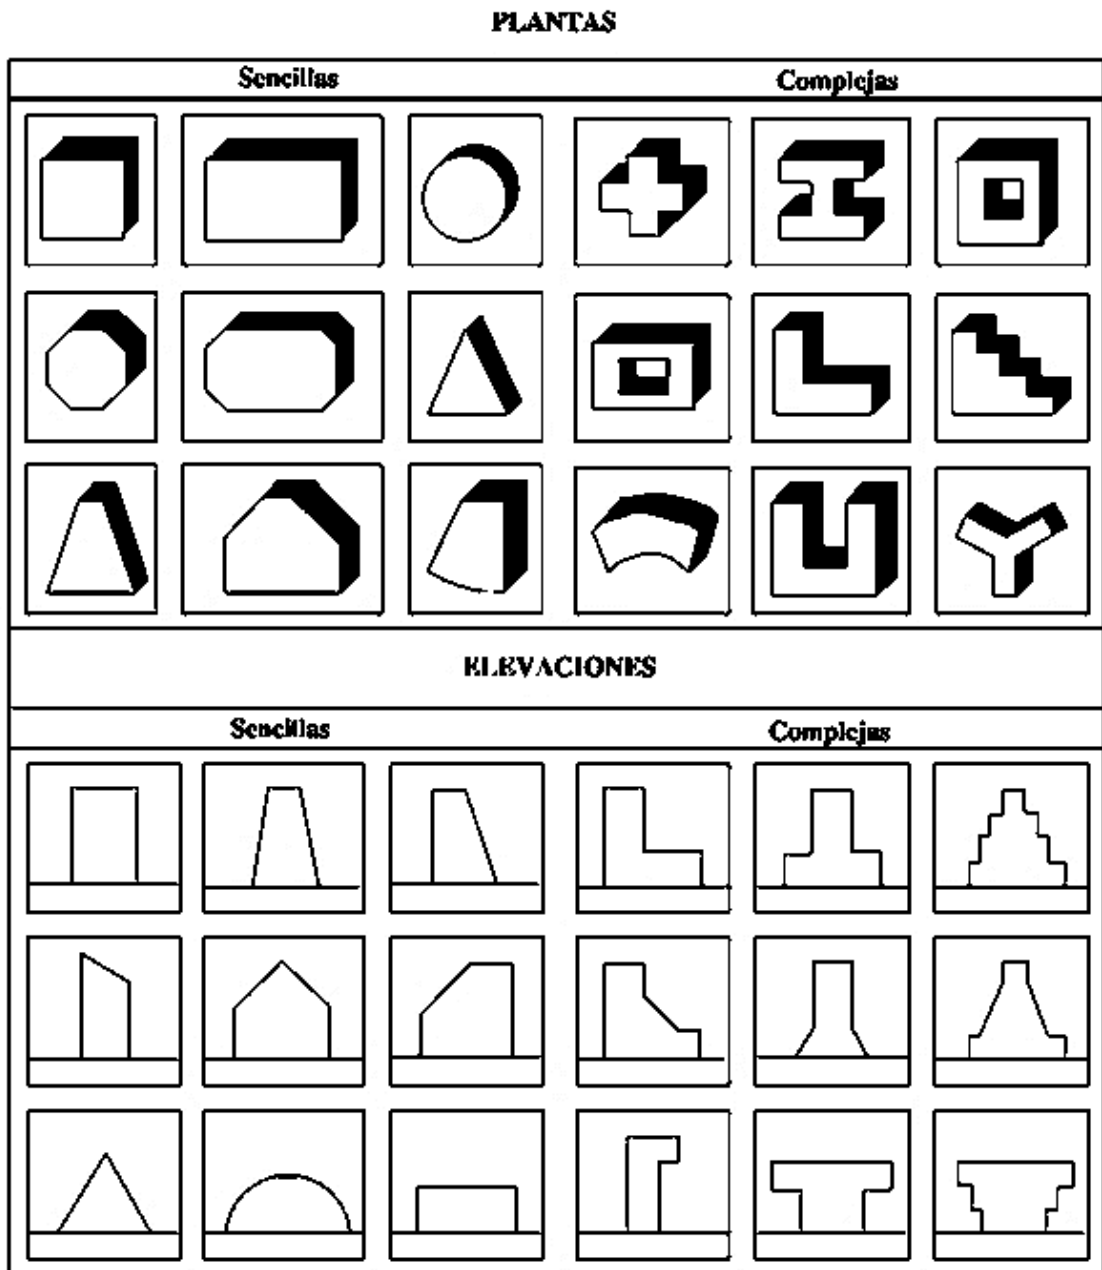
Configuraciones estructurales complejas y sencillas en planta y elevación [26]
